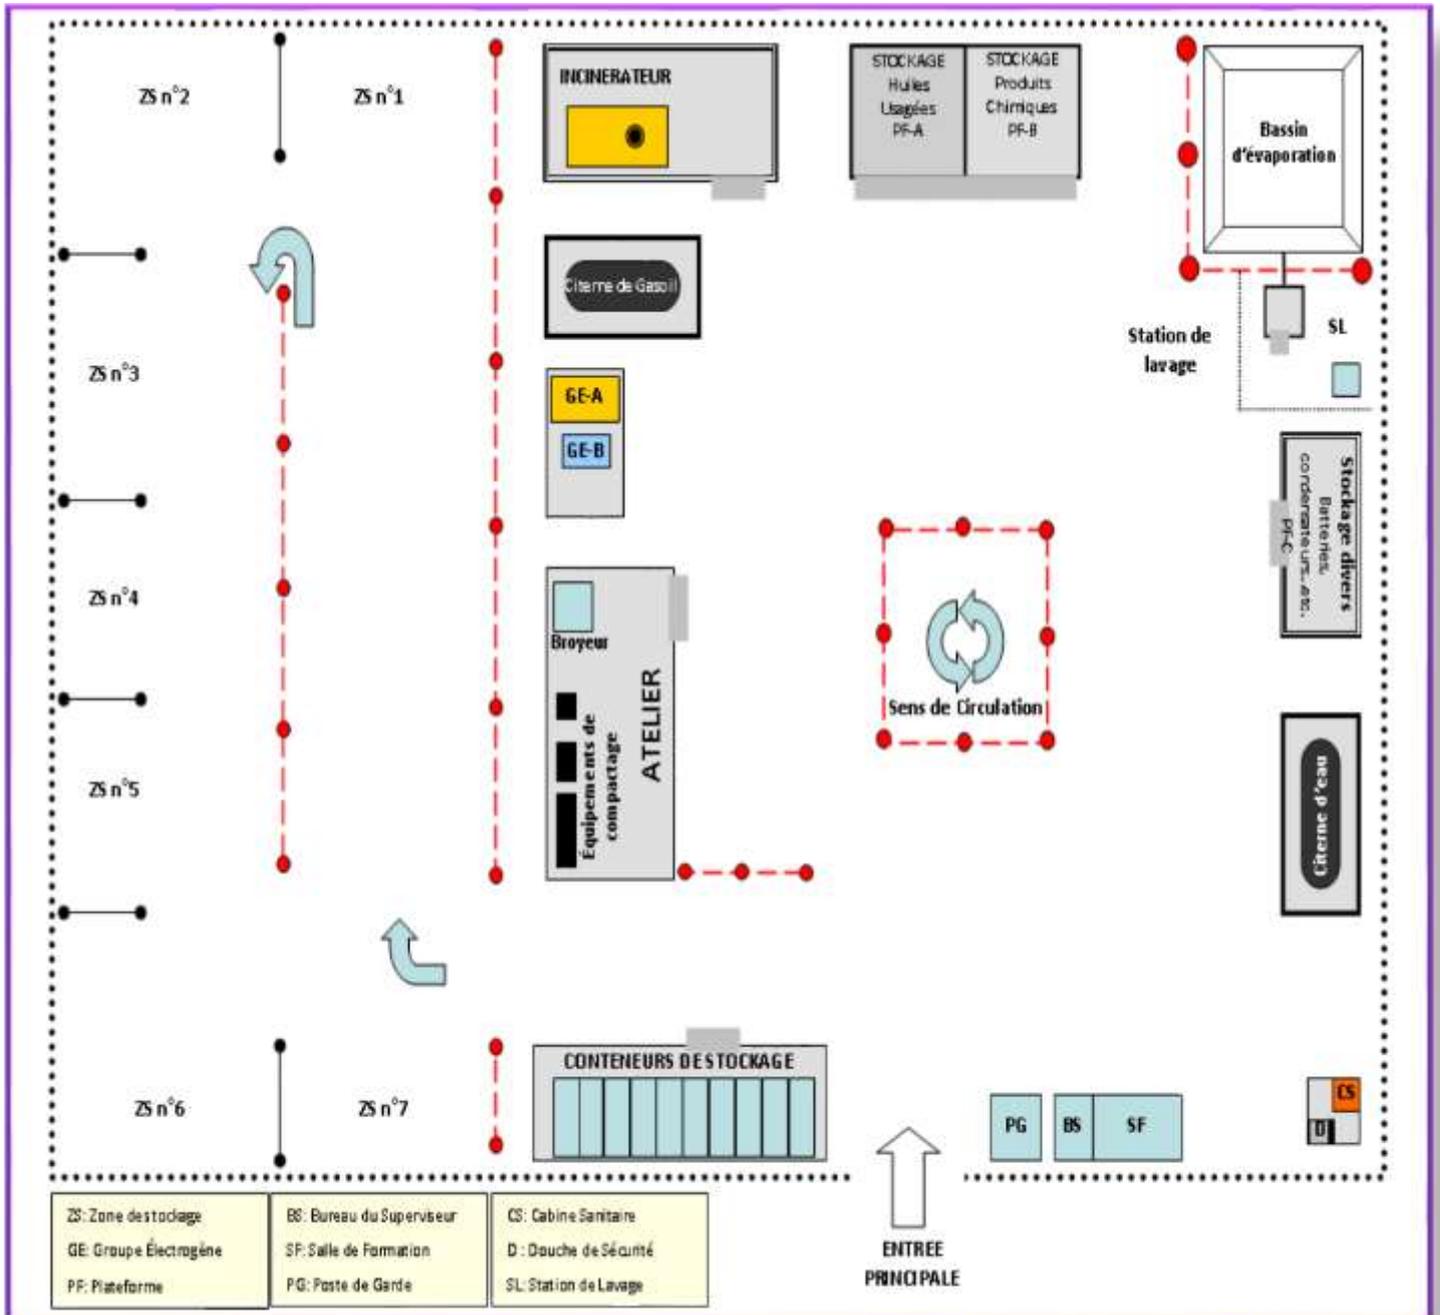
Plan du Centre de Collecte et de Tri des Déchets
